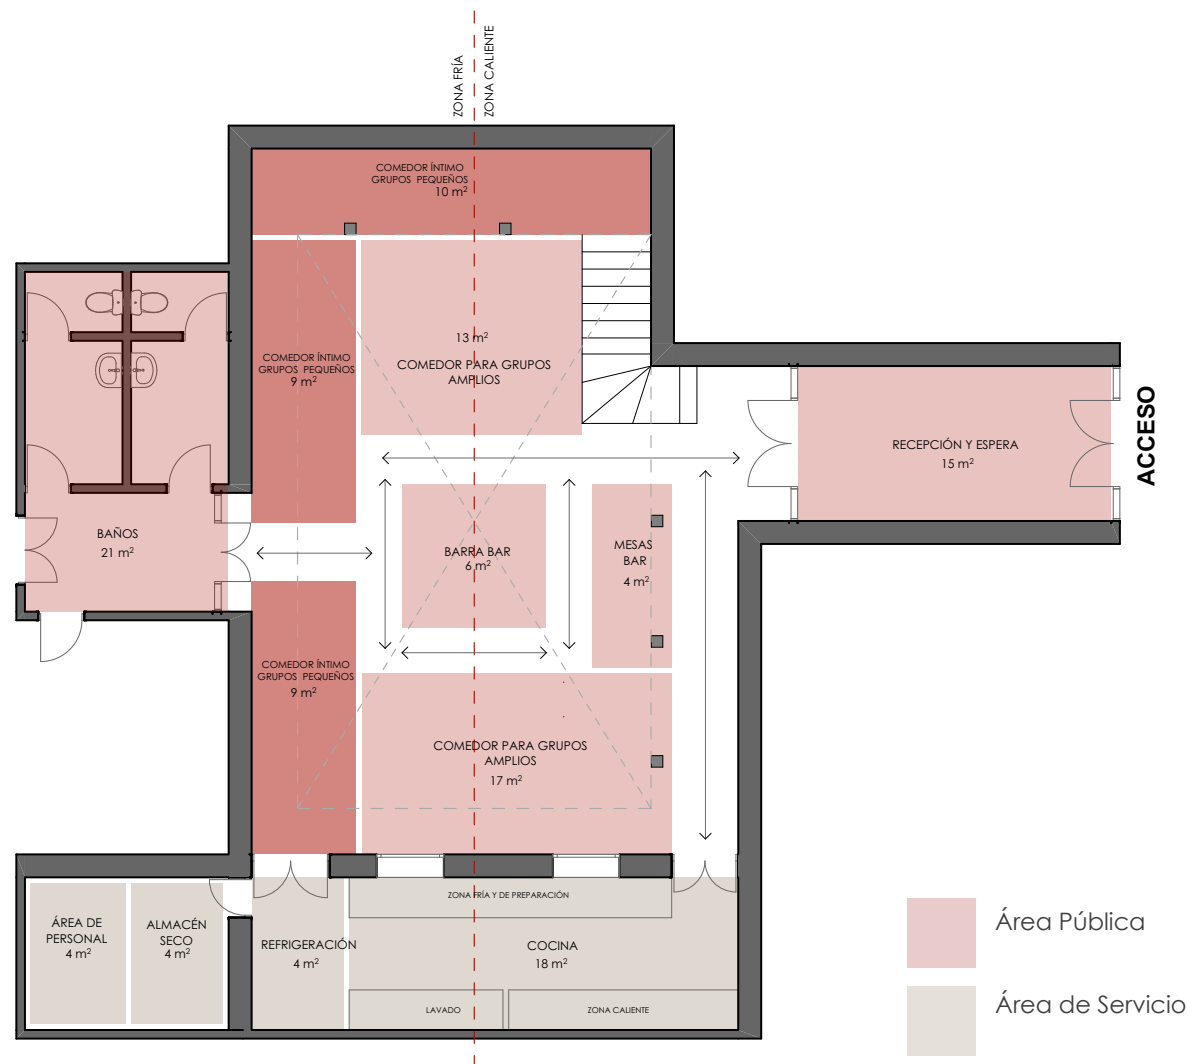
Planta de zonificación. Fuente: Elaboración Propia
